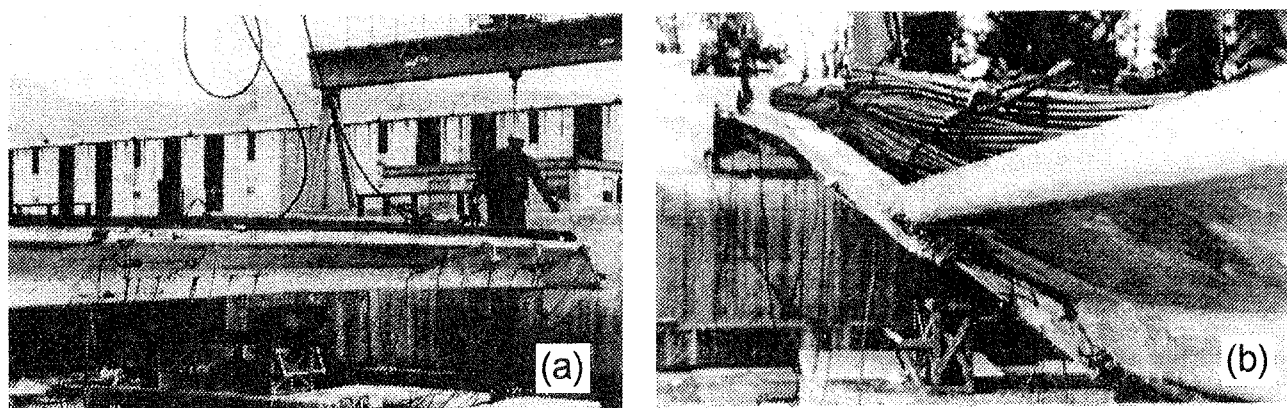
(a) Vista longitudinale del prototipo fibroarmato; (b) collasso della sezione di mezzeria.
